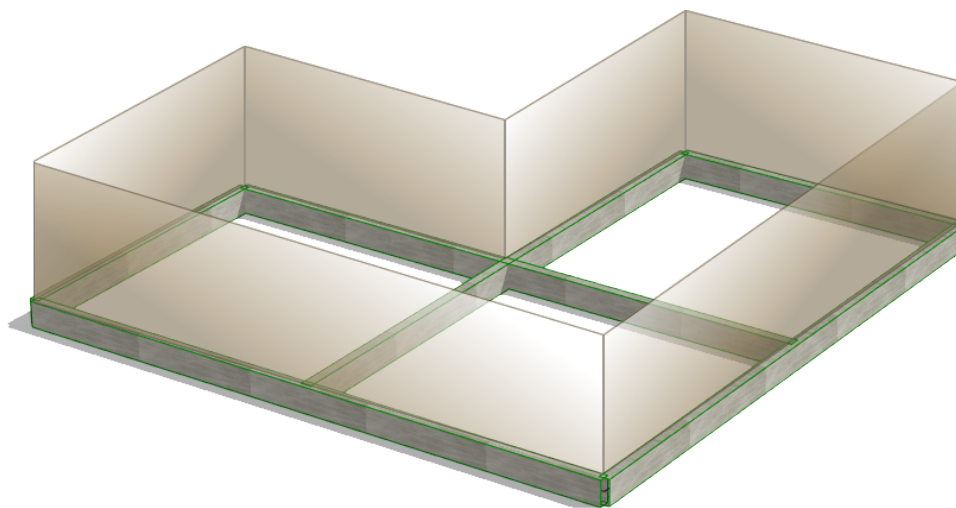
Exemplo da predefinição das vigas de um pavimento.
